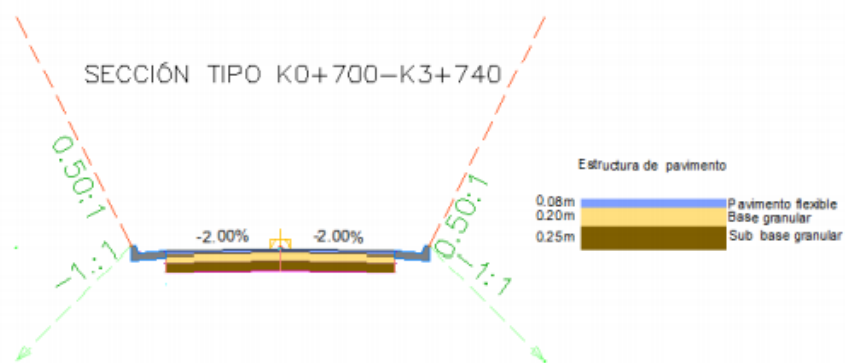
Sección transversal típica k0+700-k3+740, corredor vial Túnel- Las cruces
